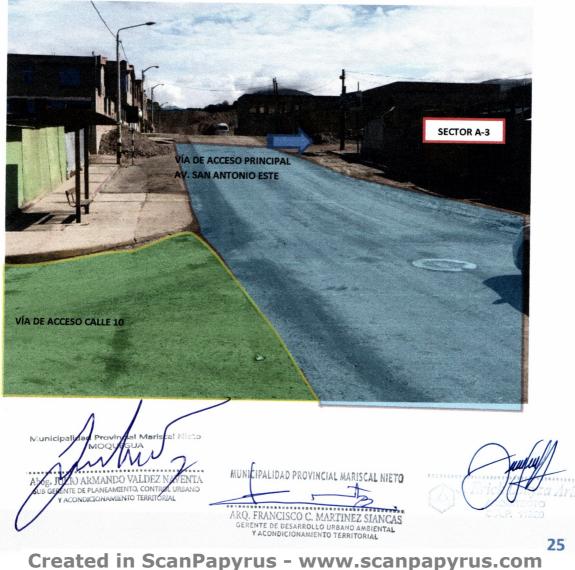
Vista hacia el norte de la principal a la zona de trabajo denominada Avenida San Antonio Este.
